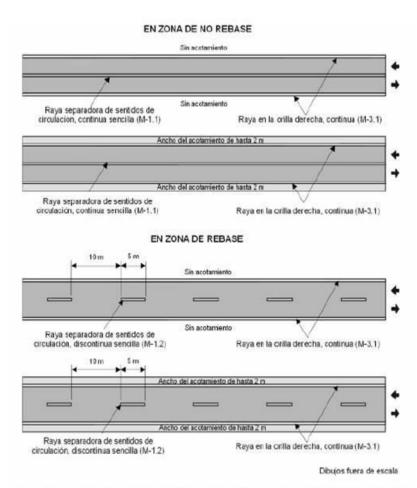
Marcas en el pavimento en carreteras con ancho de arroyo vial de hasta 6,5 m
